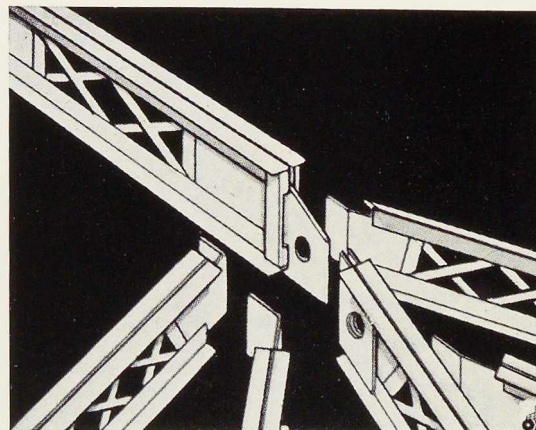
Assemblage de la faîtière et des arbalétriers.
